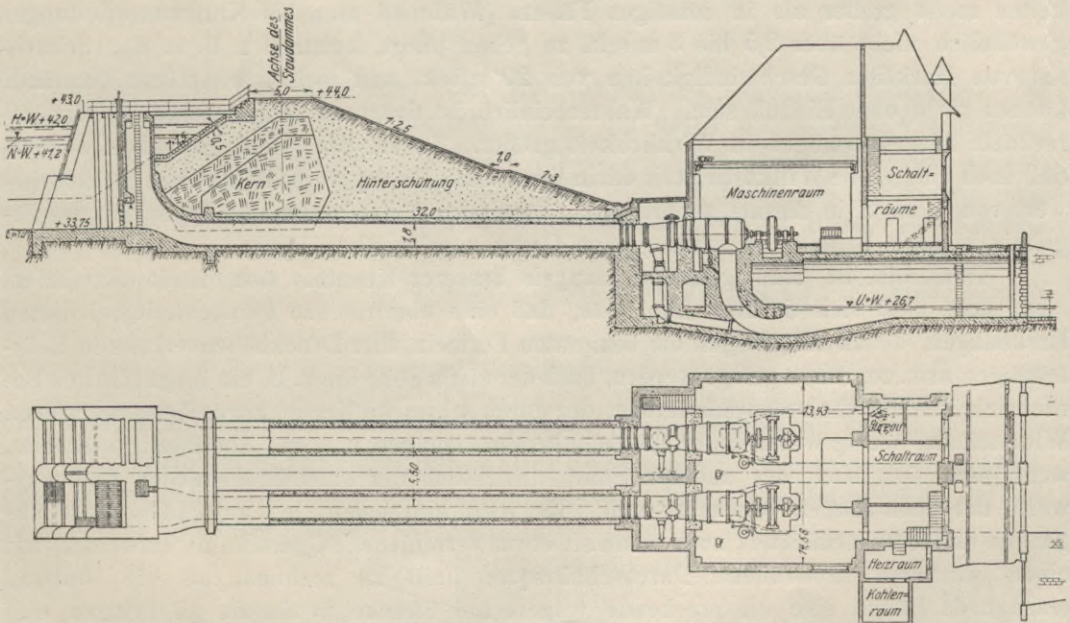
Querschnitt durch den Staudamm an der Radaune mit Kraftwerk. Maßstab 1:600.
